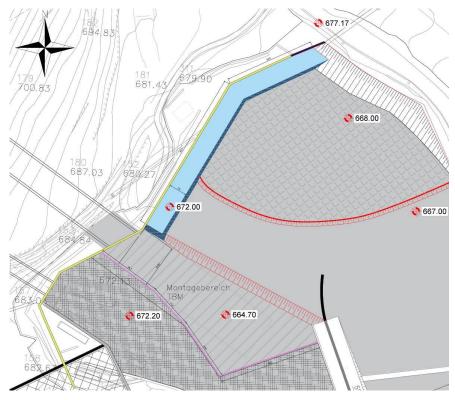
Estratto planimetria area di cantiere (dall'elaborato grafico n. PRV C3A 7582)
